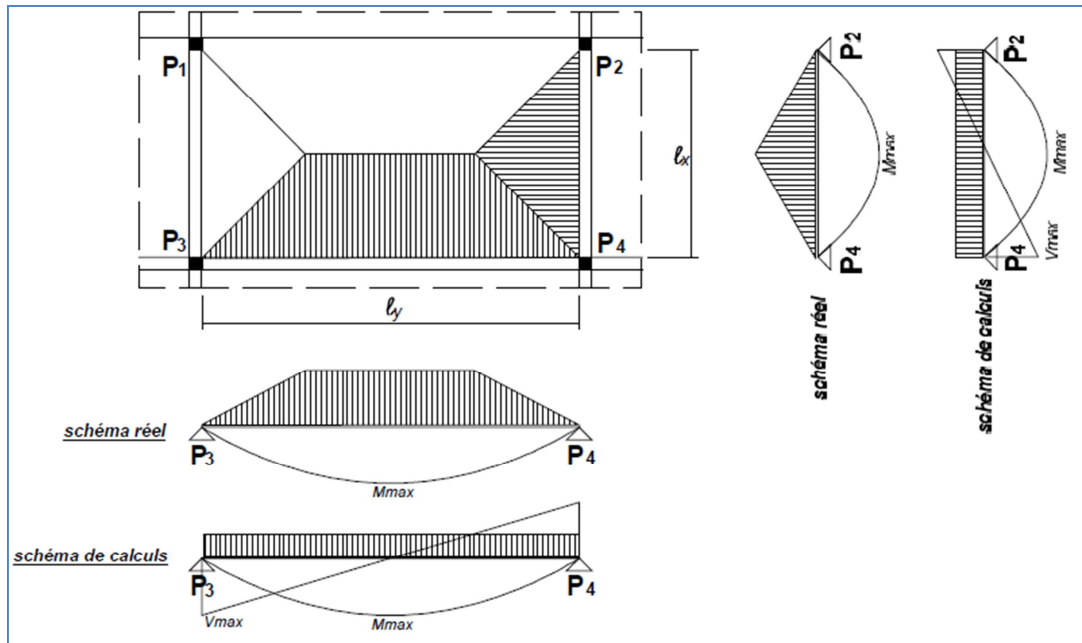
schéma de transmission du chargement de la dalle aux poutres
